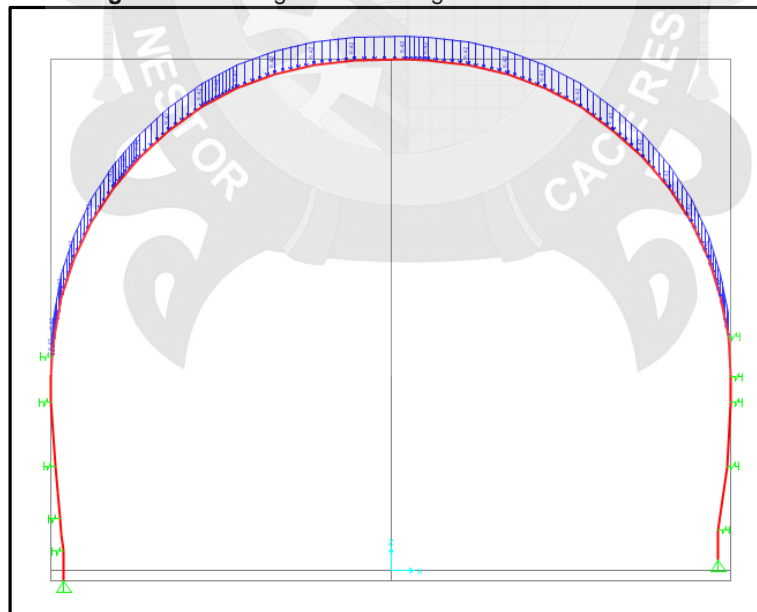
Diseño de sección de concreto lanzado más Cercha reticular en 3d
